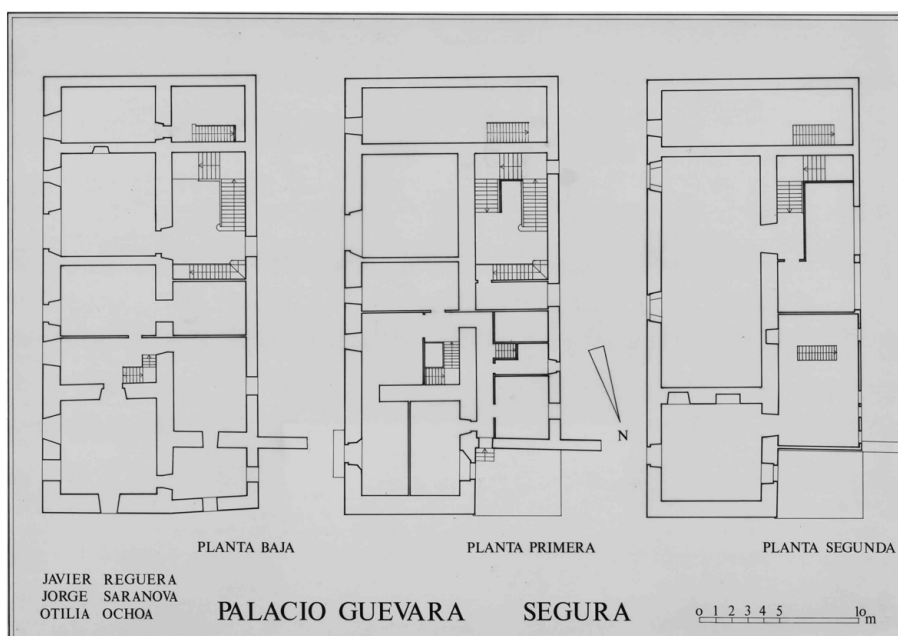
Plantas del palacio en 1985. Archivo General de Gipuzkoa
